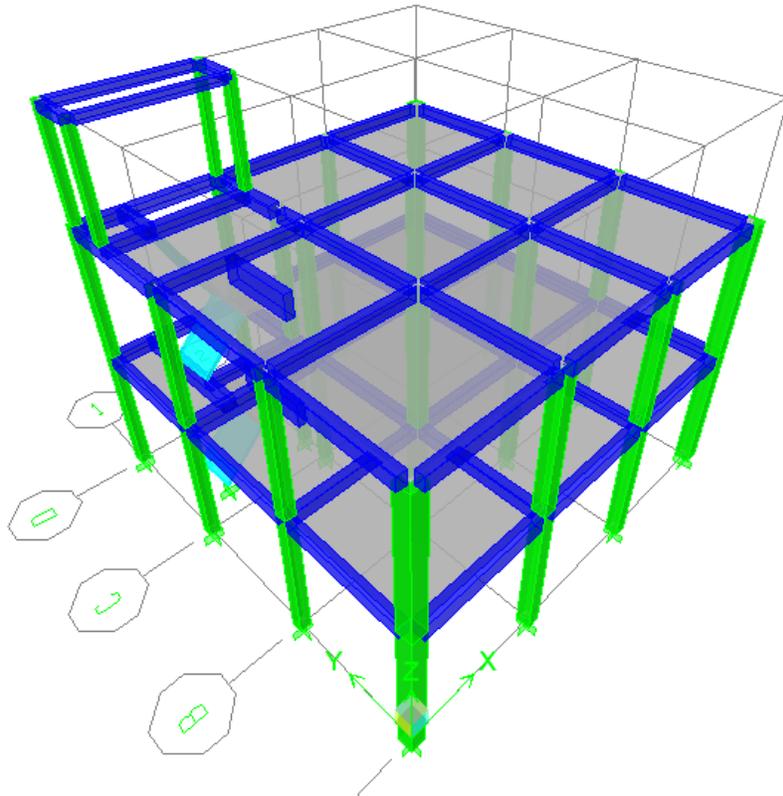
; Modelo tridimensional de la estructura Del diseño estructural de hormigón armado
